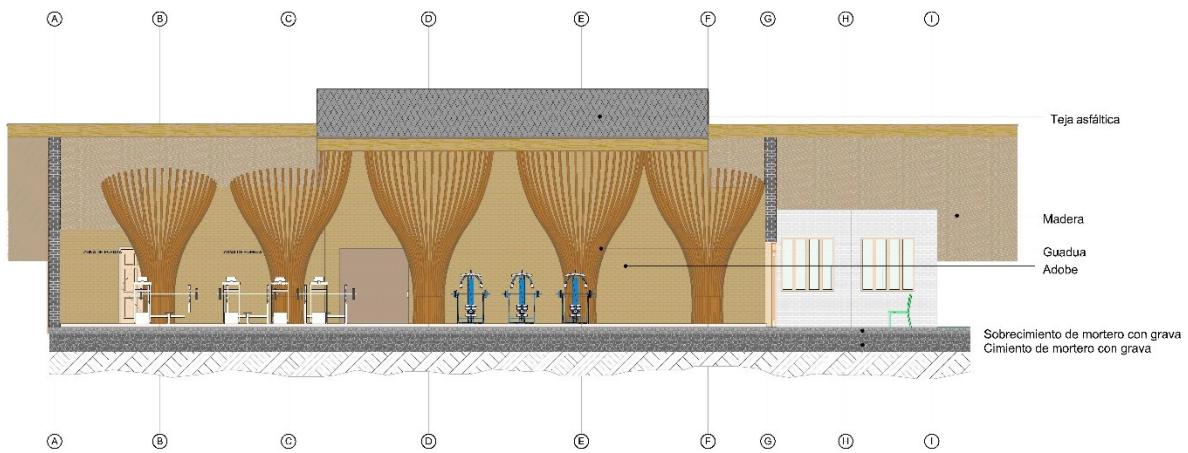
Sistema constructivo en adobe. Fuente (Elaboración propia)
